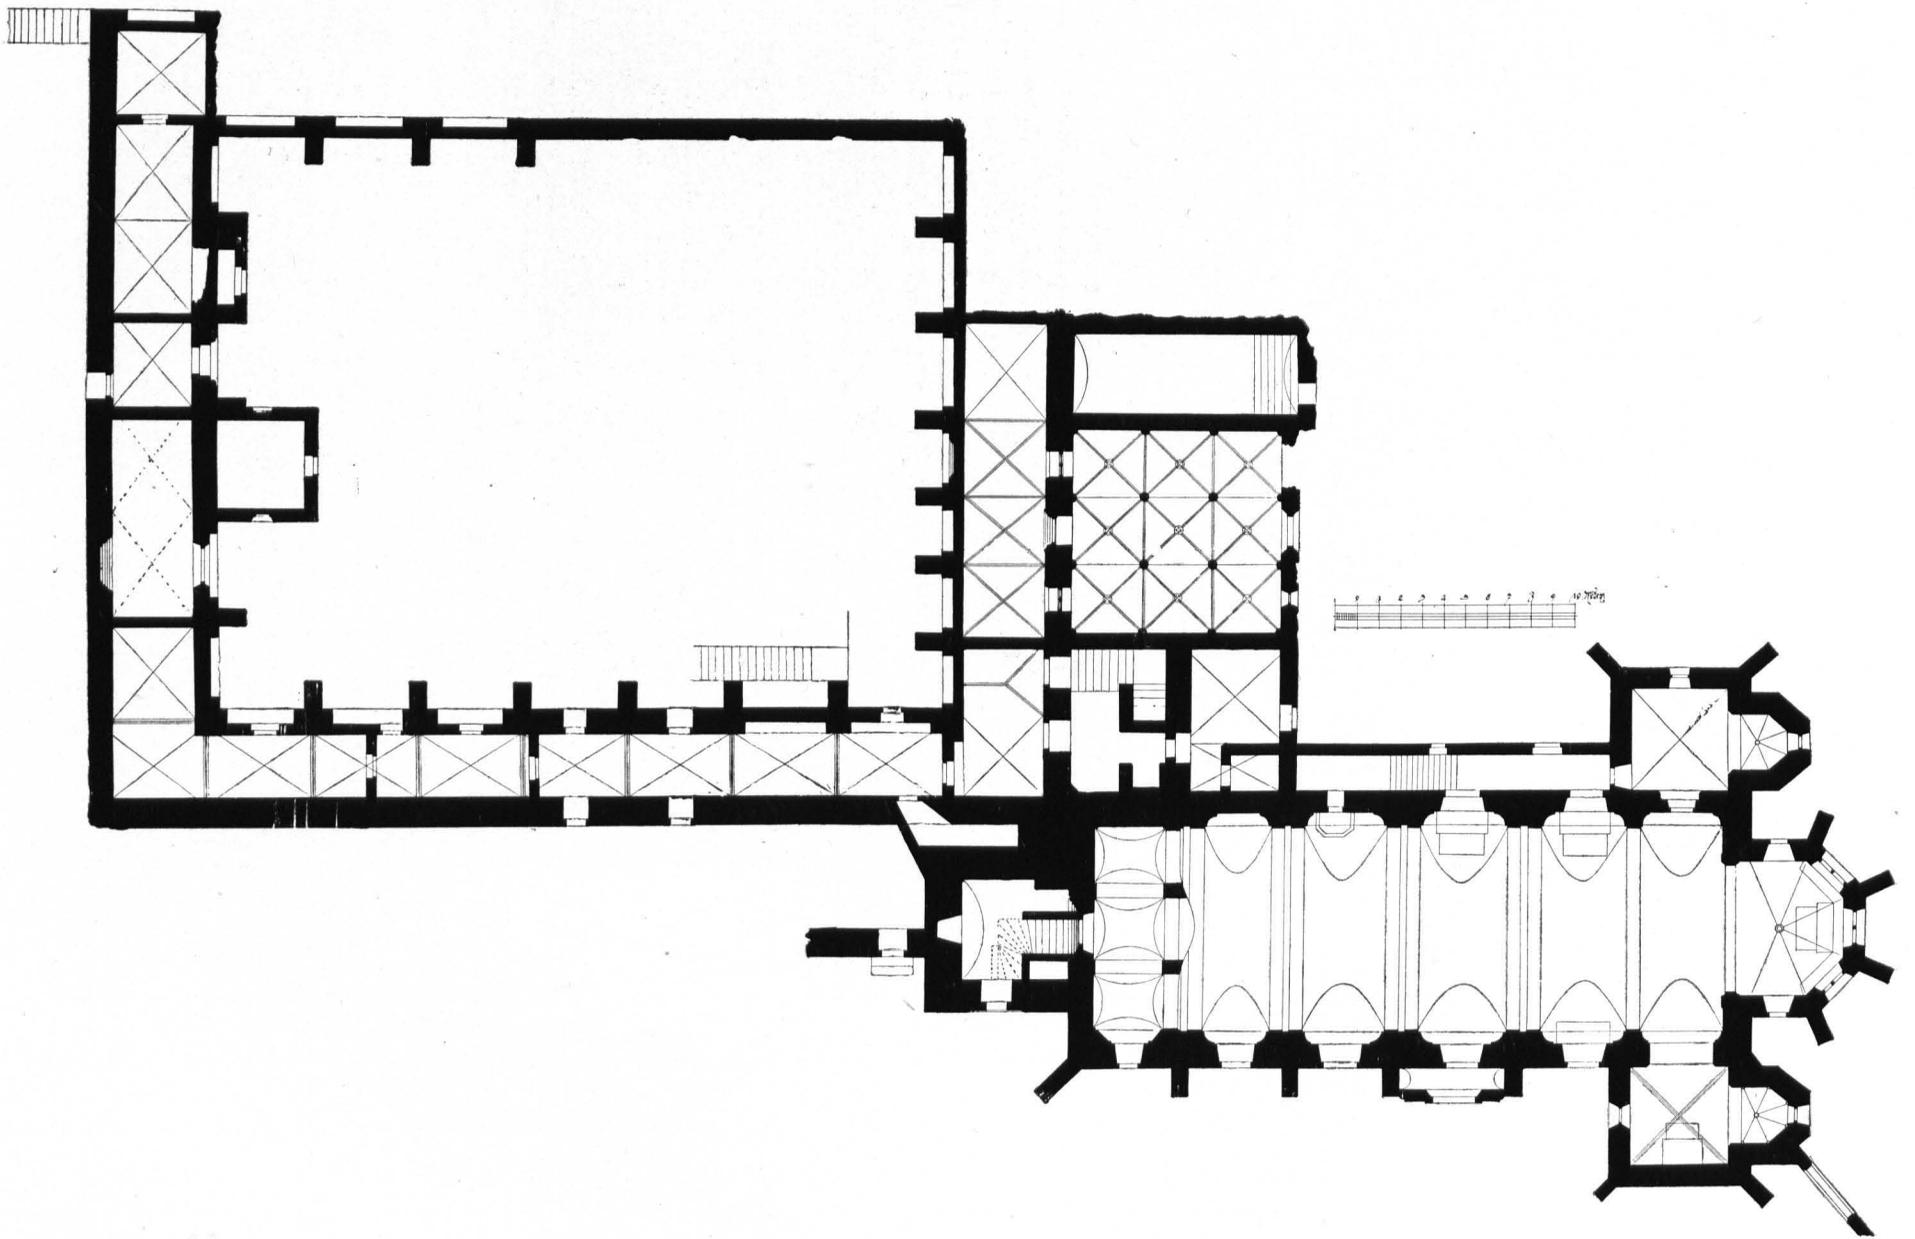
St. Bernhard, Kirche, Kapitelsaal und Kreuzgang, Grundriß 1:350 (S. 324)
